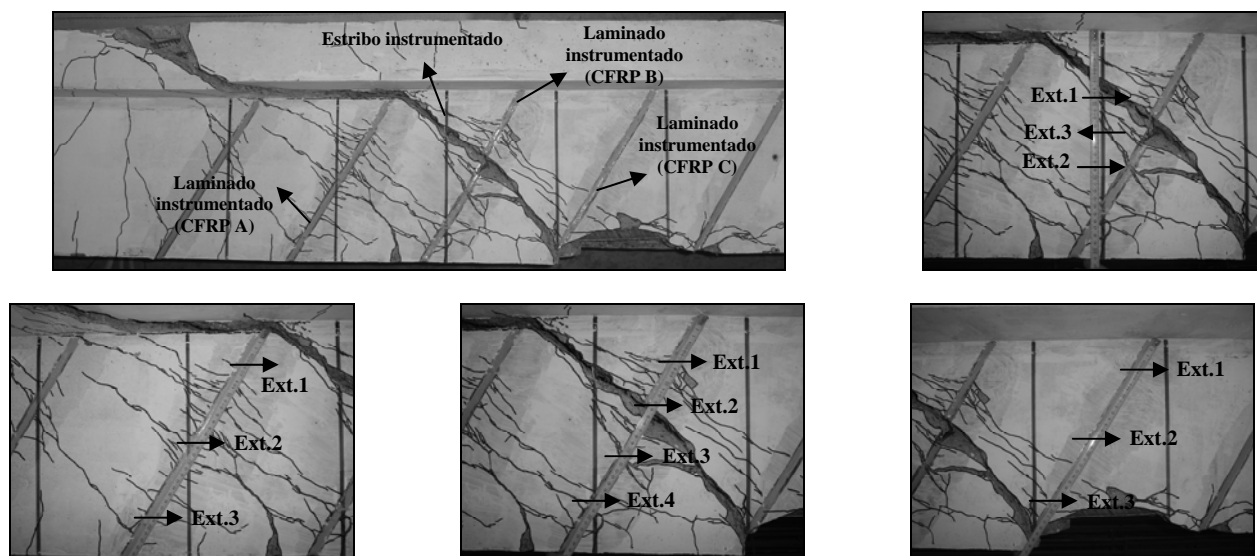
Localização dos extensômetros no laminado e estribo instrumentados da viga 5S-5LI60-D.
